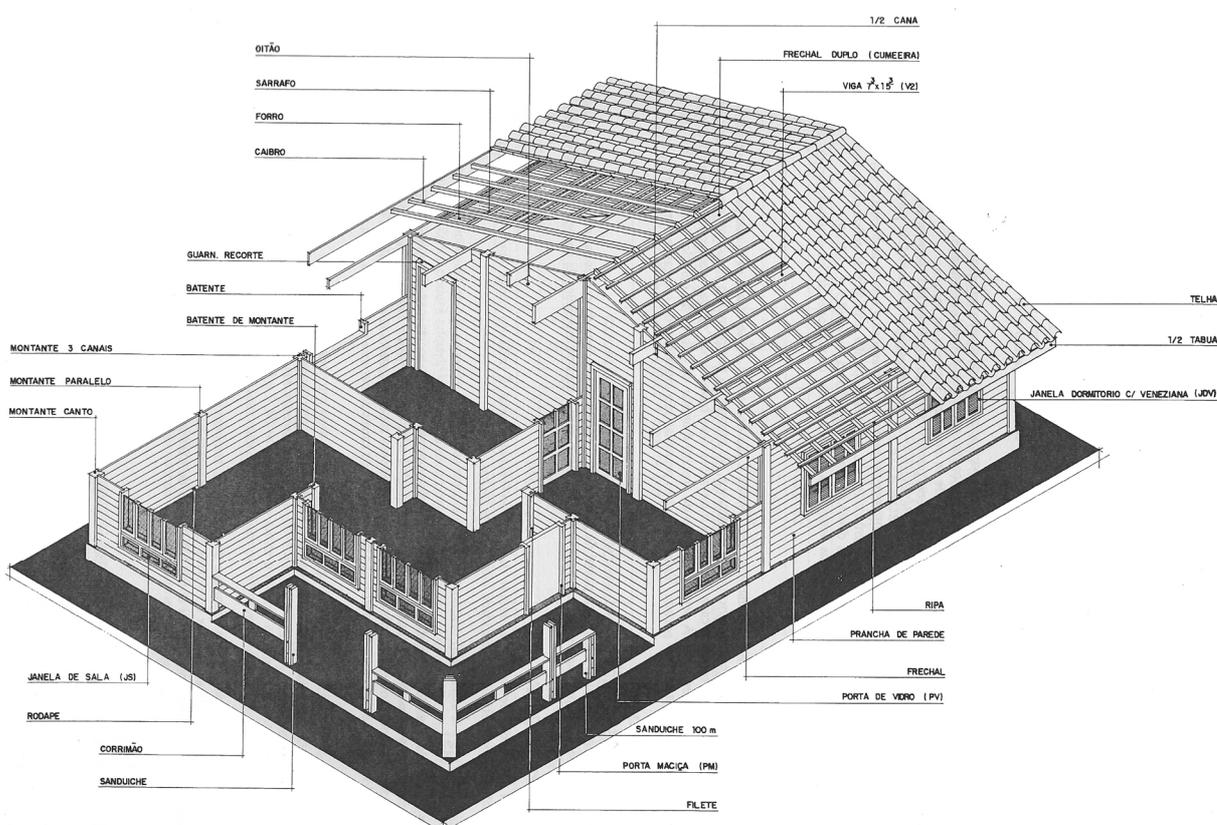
Esquema construtivo de uma casa de "Encaixe"
